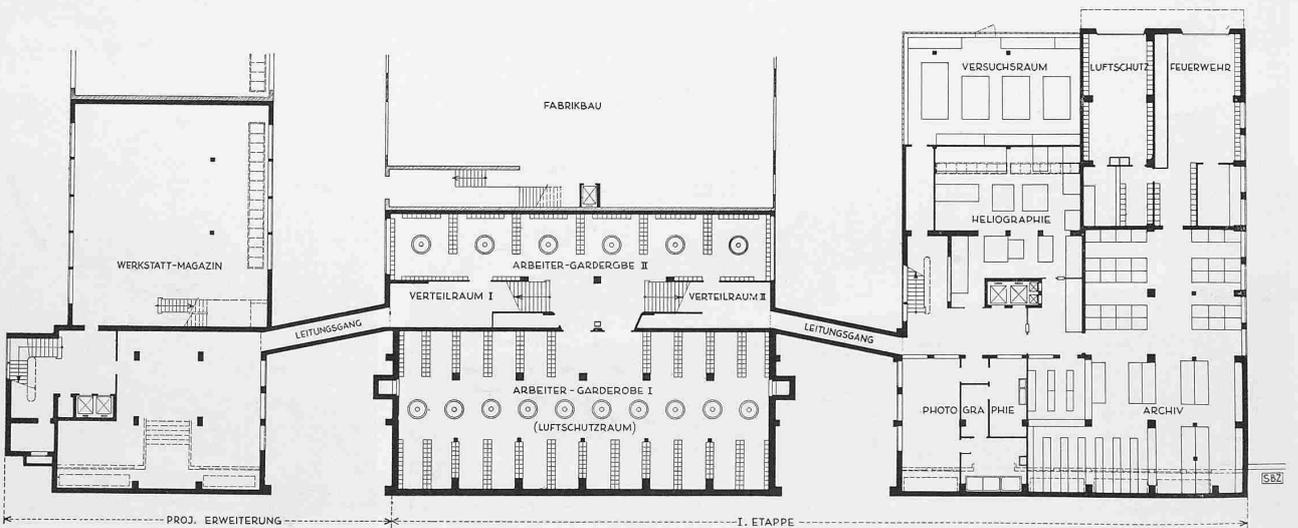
Grundriss vom Untergeschoss des ganzen Bureauegebäudes (ausgeführt ist z. Zt. nur die «I. Etappe»). — Masstab 1 : 500
